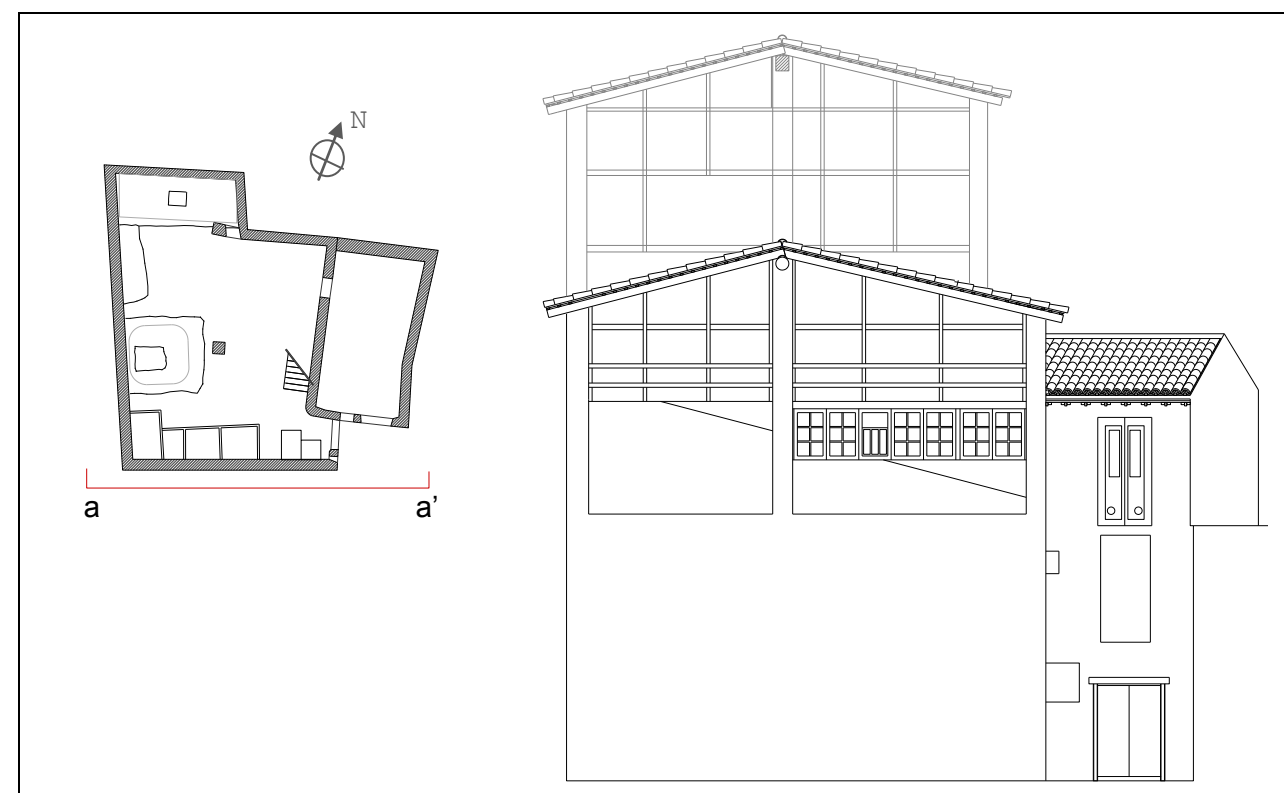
La Tuta amb la planta segona tancada per aixecament d'una nova planta a l'edifici colindant pel sud.
